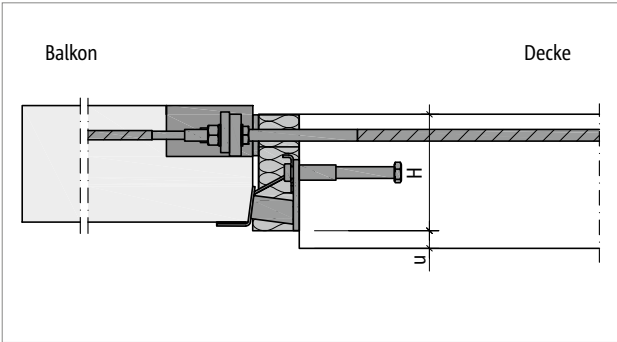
Schöck Isokorb® IQ Typ K-B: Abstand u [mm]
